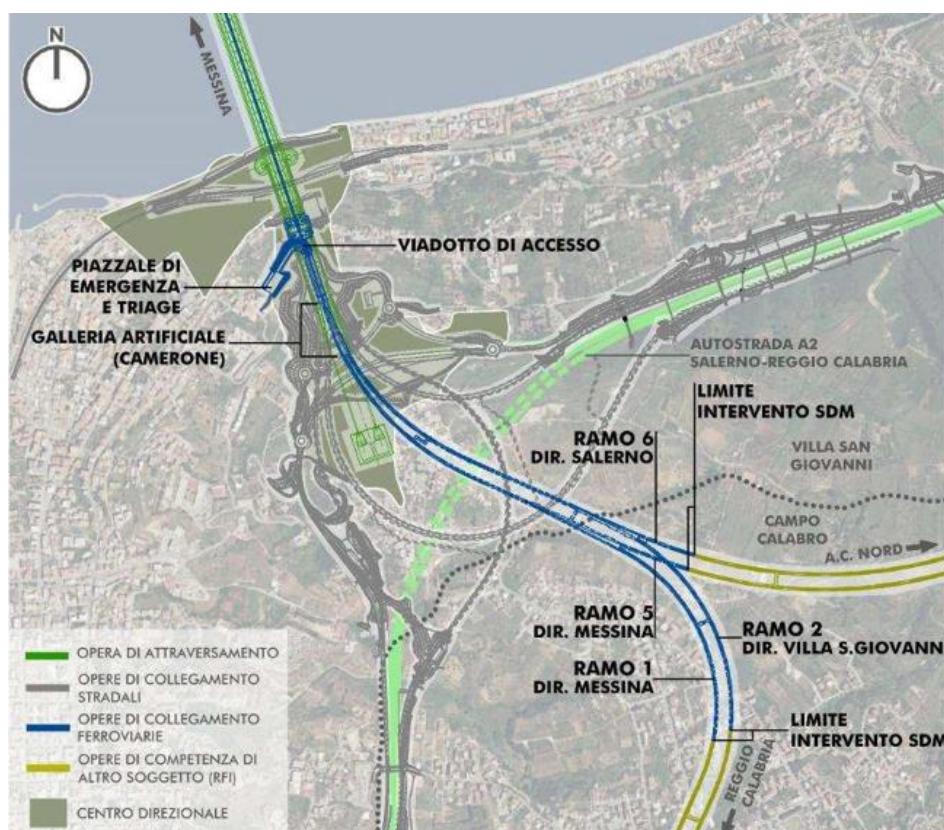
Stralcio planimetrico con indicazione dei rami costituenti i collegamenti ferroviari di progetto sul versante Calabria
